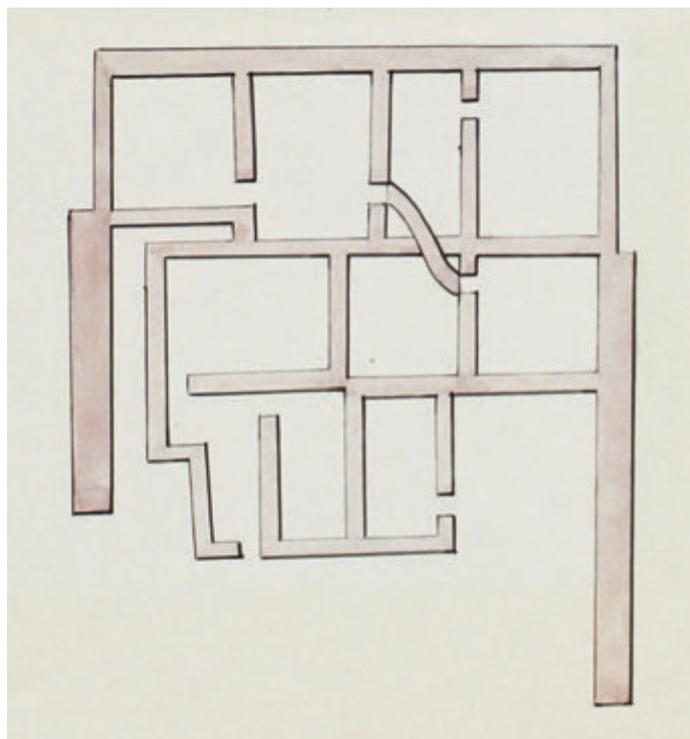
, plano no. 1. Plano de un edificio de Tollan. Dibujo a pluma.
